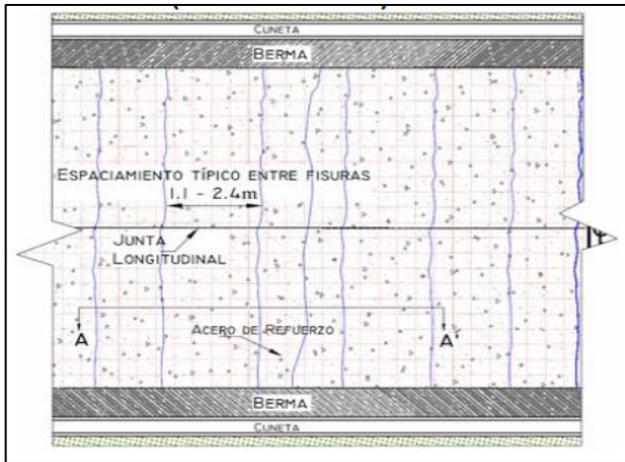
Pavimento Rígido Continuamente Reforzado (INVIAS, 2006).
